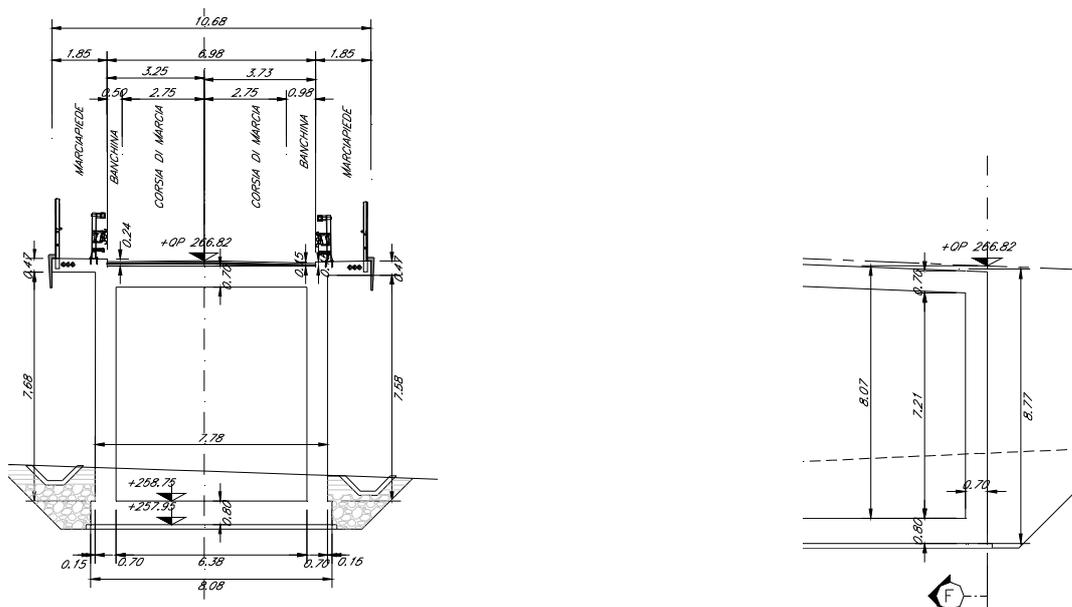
Schemi sezioni trasversale e longitudinale della sezione terminale della rampa Est
